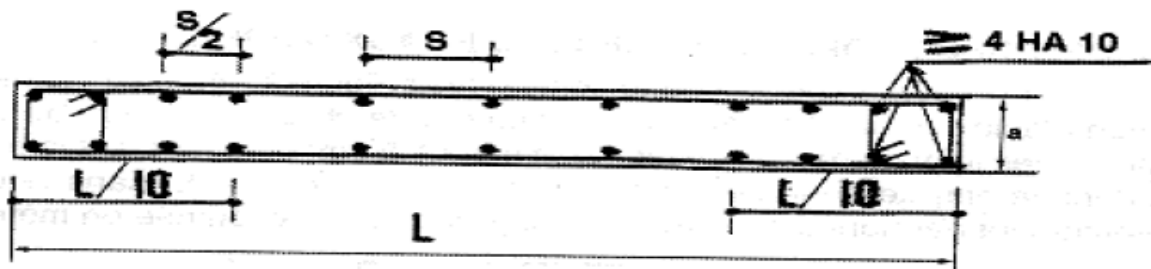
Disposition du ferrailage dans un voile plein classique. [10]
